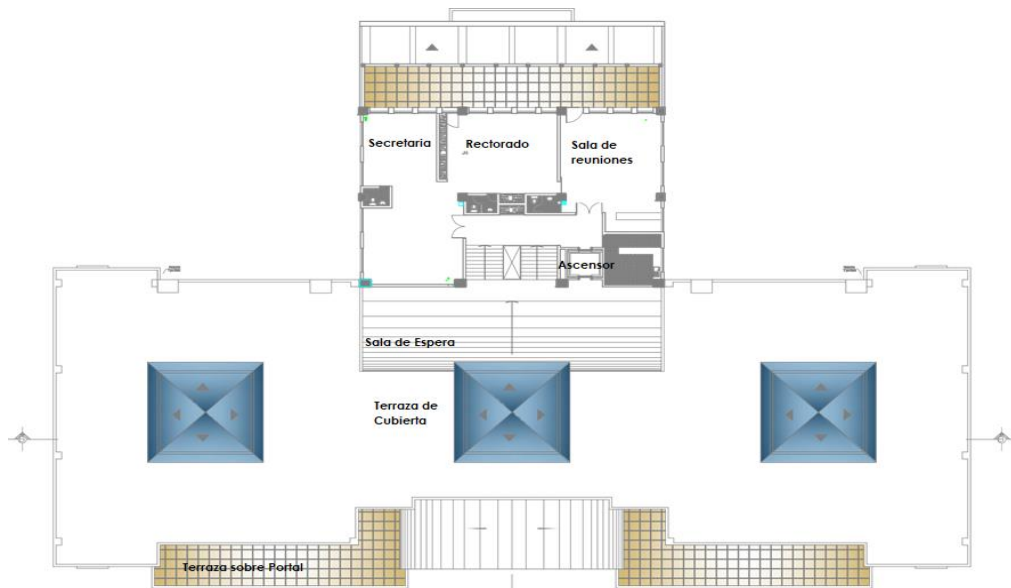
Planos de Infraestructura Edificio Central Planta Alta 3
